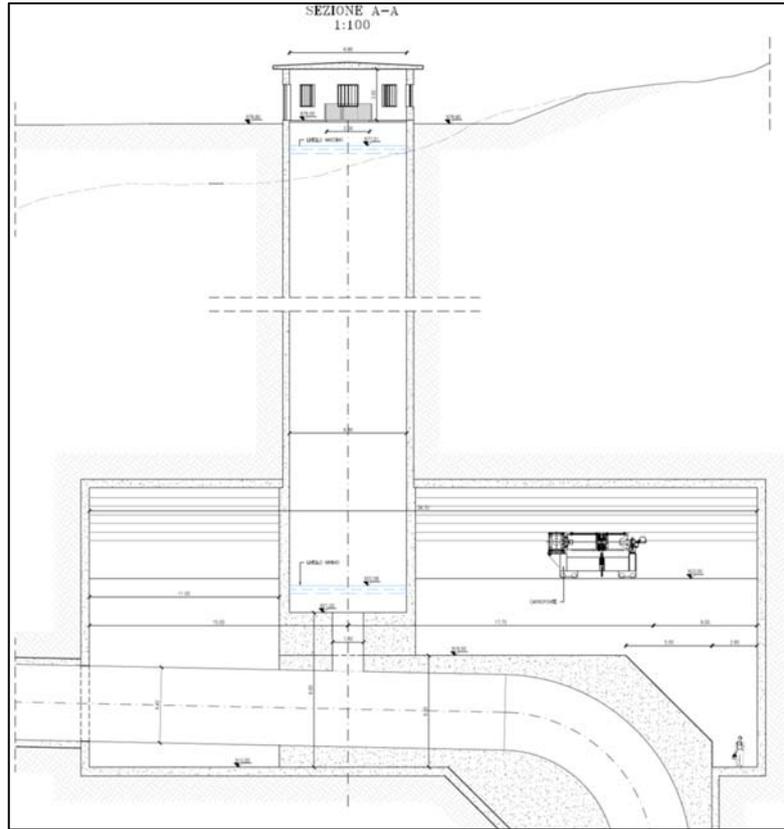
Sezione del pozzo piezometrico e della caverna alla sua base
